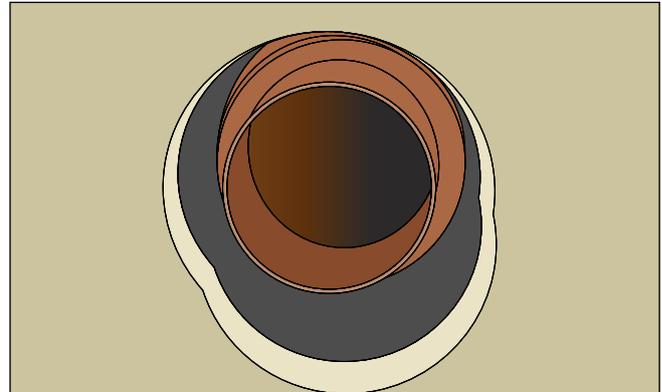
Ilustrações de ligações de ramais em más condições estruturais (2)
